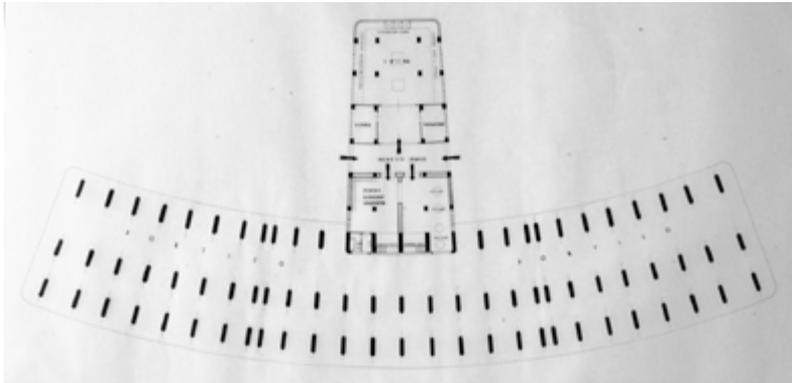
Pianta del piano terra, quarto progetto (© Paolo Sanjust)
